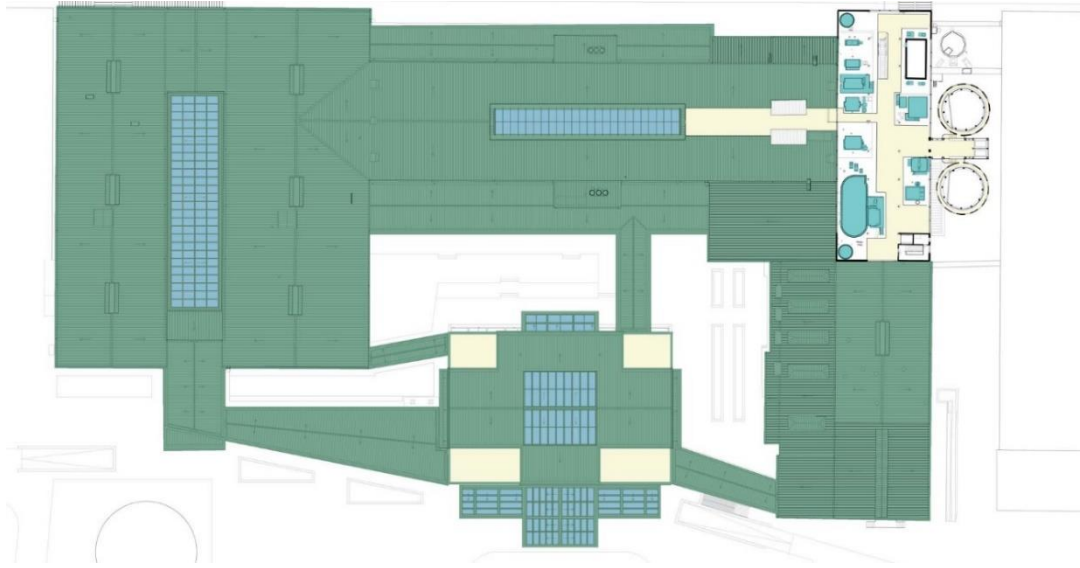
Seka Kağıt Fabrikası Mevcut Yapı +8.50 Kot Planı
